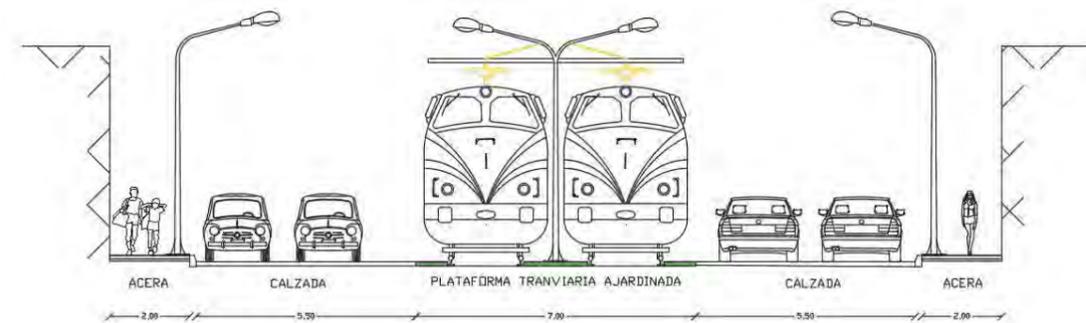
Sección tipo E (cotas en m). Fuente: Elaboración propia
